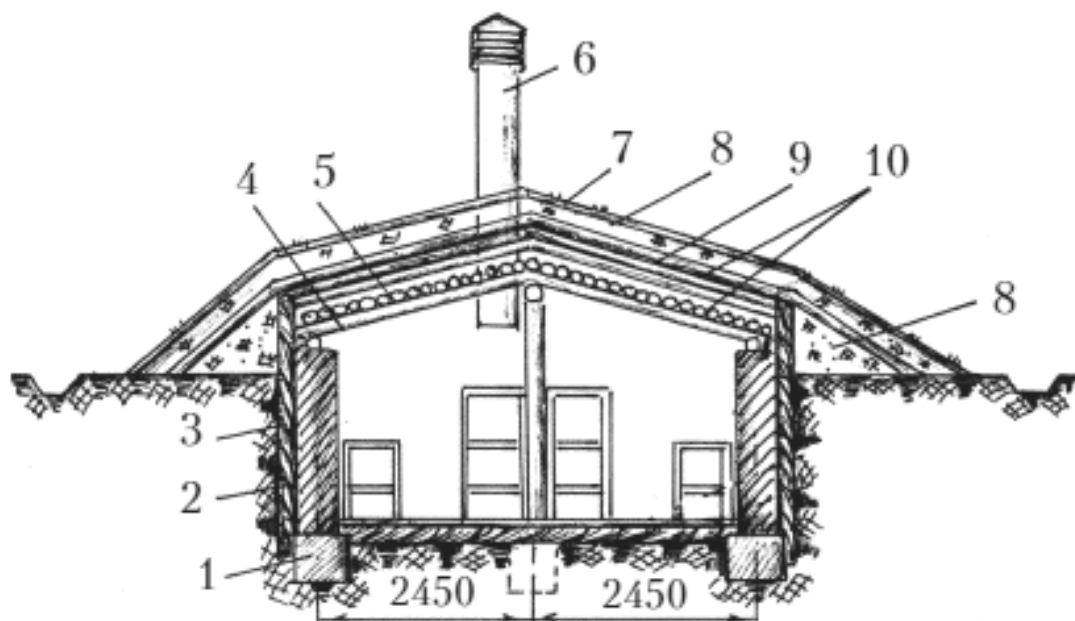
Поперечный разрез подземного зимовника на 108 пчелиных семей (размеры в мм): 1 – фундамент; 2 – стены; 3 – глина; 4 – стропила; 5 – накат; 6 – вытяжная шахта; 7 – дерн; 8 – земля; 9 – песок; 10 – утепление
